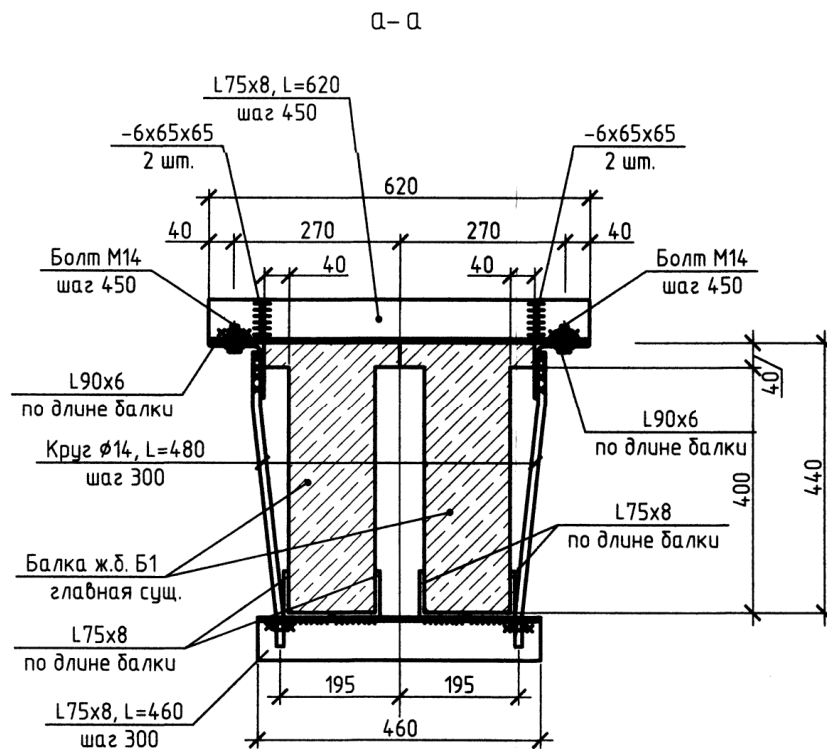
Усиленная балка перекрытий Б-1 в осях 8-13/Б-Д согласно рабочей документации
